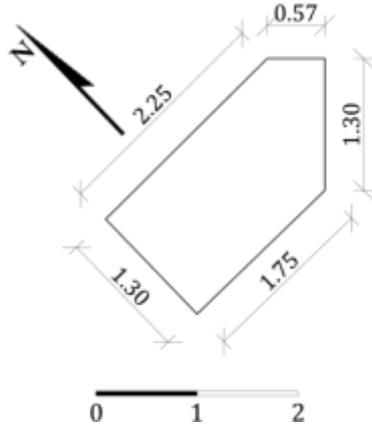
مسقط أفقي لمنور بدهليز
